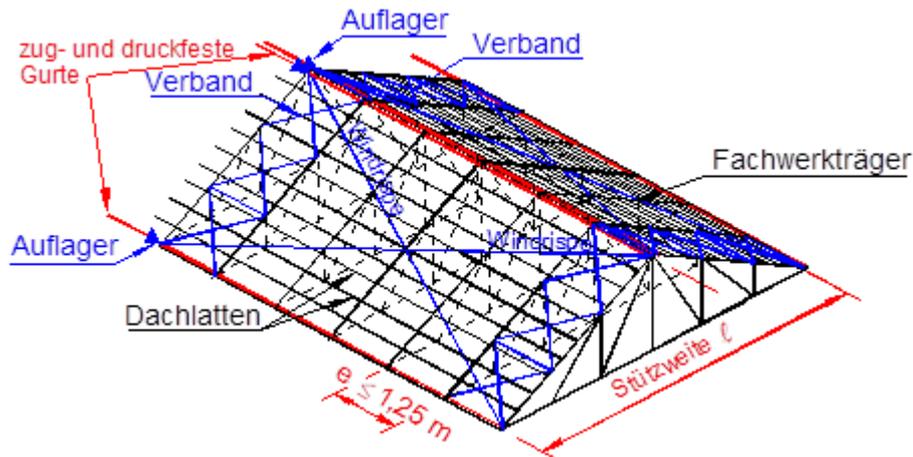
Fachwerkträger mit der Stützweite  $e$ , den Verbänden in der Dachebene, den druck- und zugfesten Gurten an Traufe und First und der Abspannung durch Windrispen
